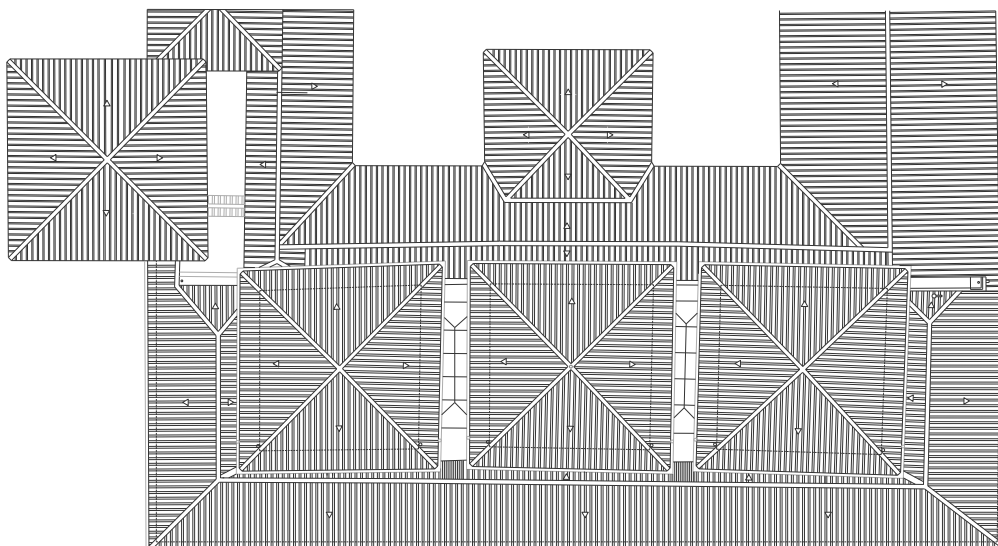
Sala de los Reyes. Planta de cubiertas. Estado final de obra. (Pedro Salmerón Escobar, 2010).
